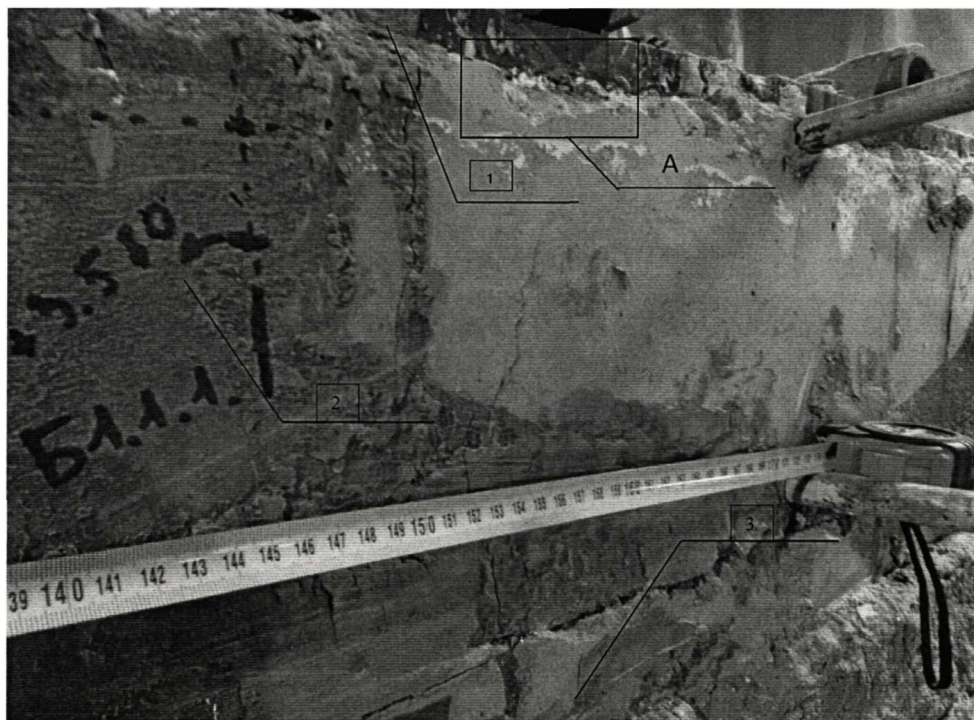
Вид на стик бетону з днищем апарату після демонтажу (демонтажу бічної металевої опалубки): 1 - Корпус обладнання; 2 - Бетон після теплових випробувань; 3 - Опорна плита
